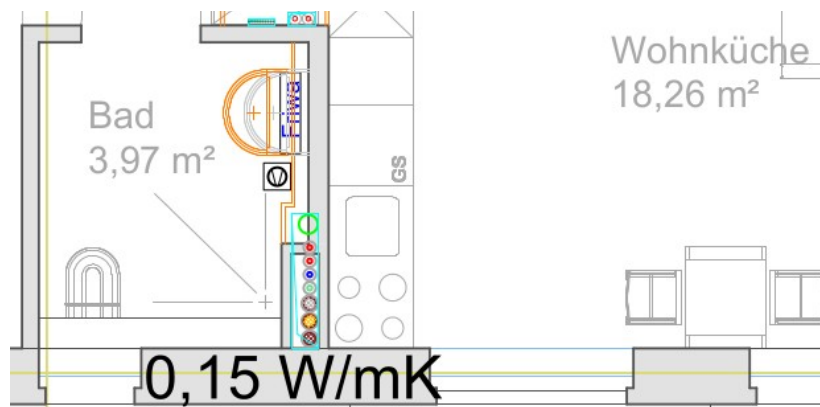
Leitungsschacht eines Bades im Planungsbeispiel WSX mit Braun-, Grau-, Gelb-, Betriebs-, Trinkwasser-, Heizungs-, und Lüftungsleitungen, Quelle: TGA-Fachplanung, Ergo Sun
